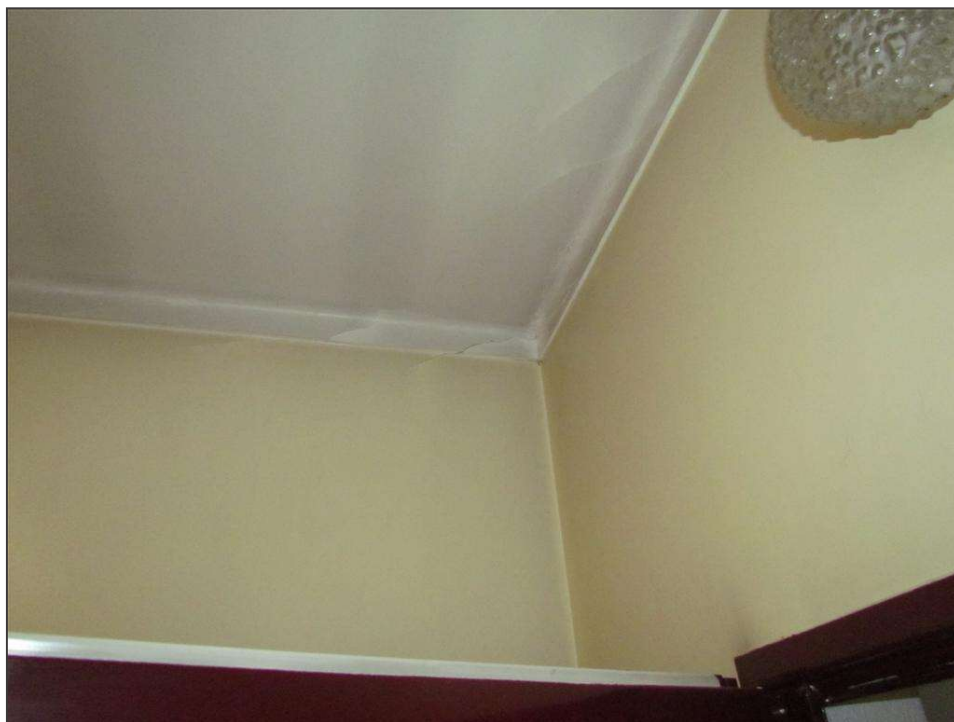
Fissuração no teto junto ao roda-teto e manchas no revestimento do teto
